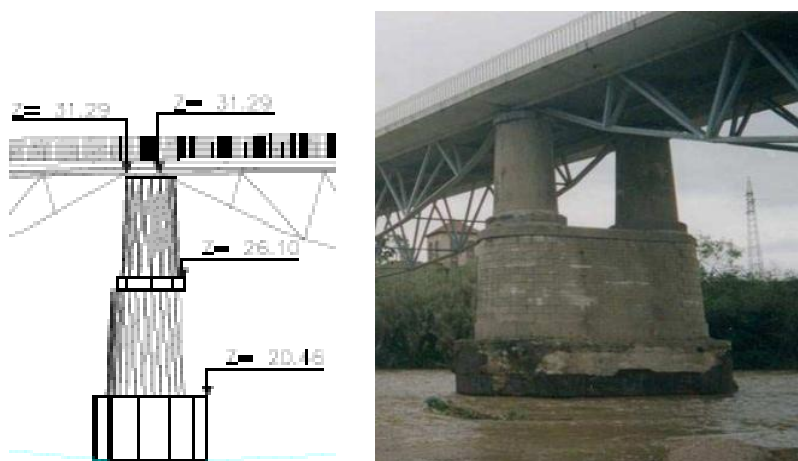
Pilas del puente de la N-II.<sup>100</sup>
